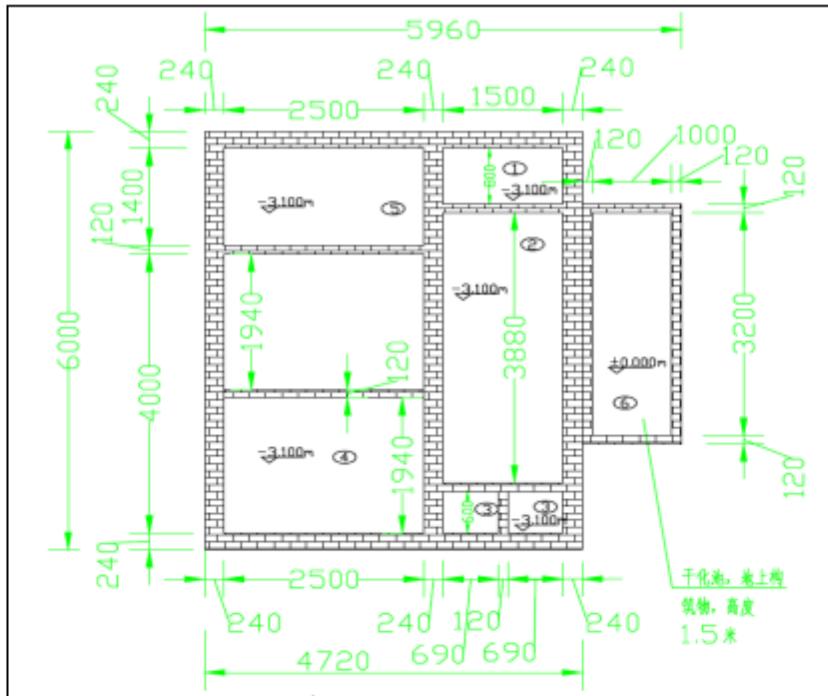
厂区沉淀池污水处理构筑物平面布置图
